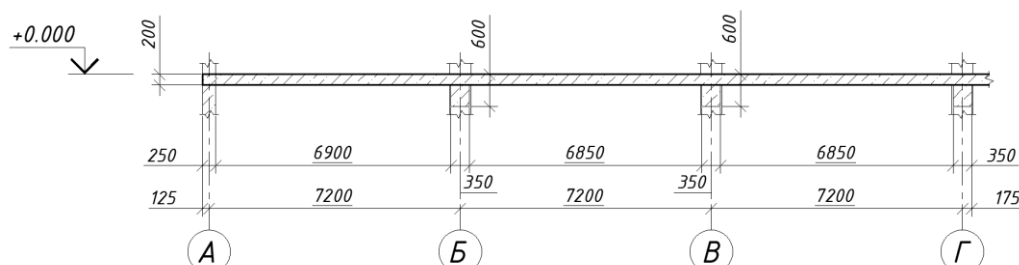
Неразрезная многопролетная балка, опертая на главные балки и наружные стены
